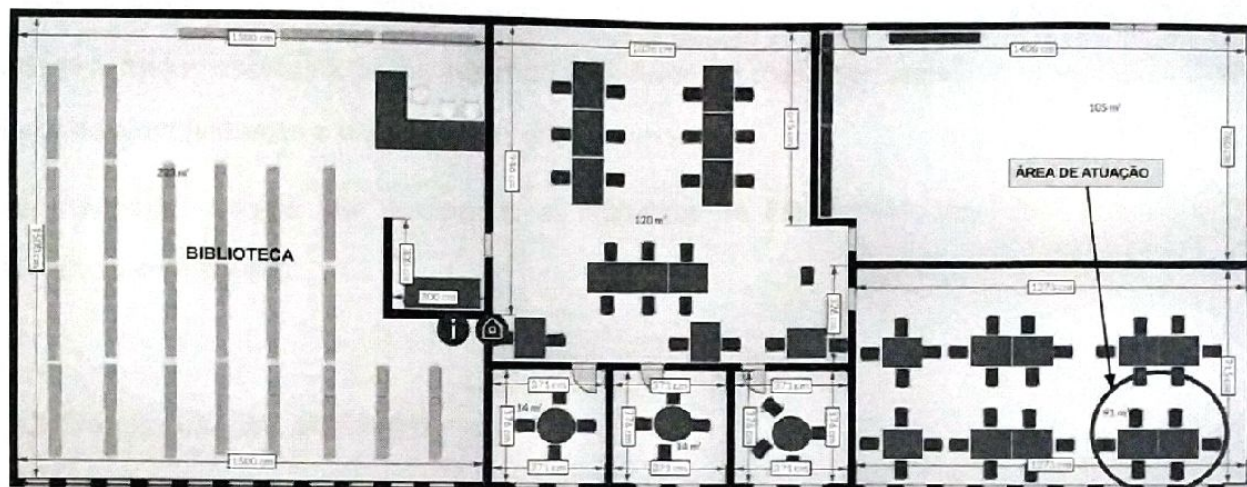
(Planta da Biblioteca do Centro Universitário Una-Betim)
